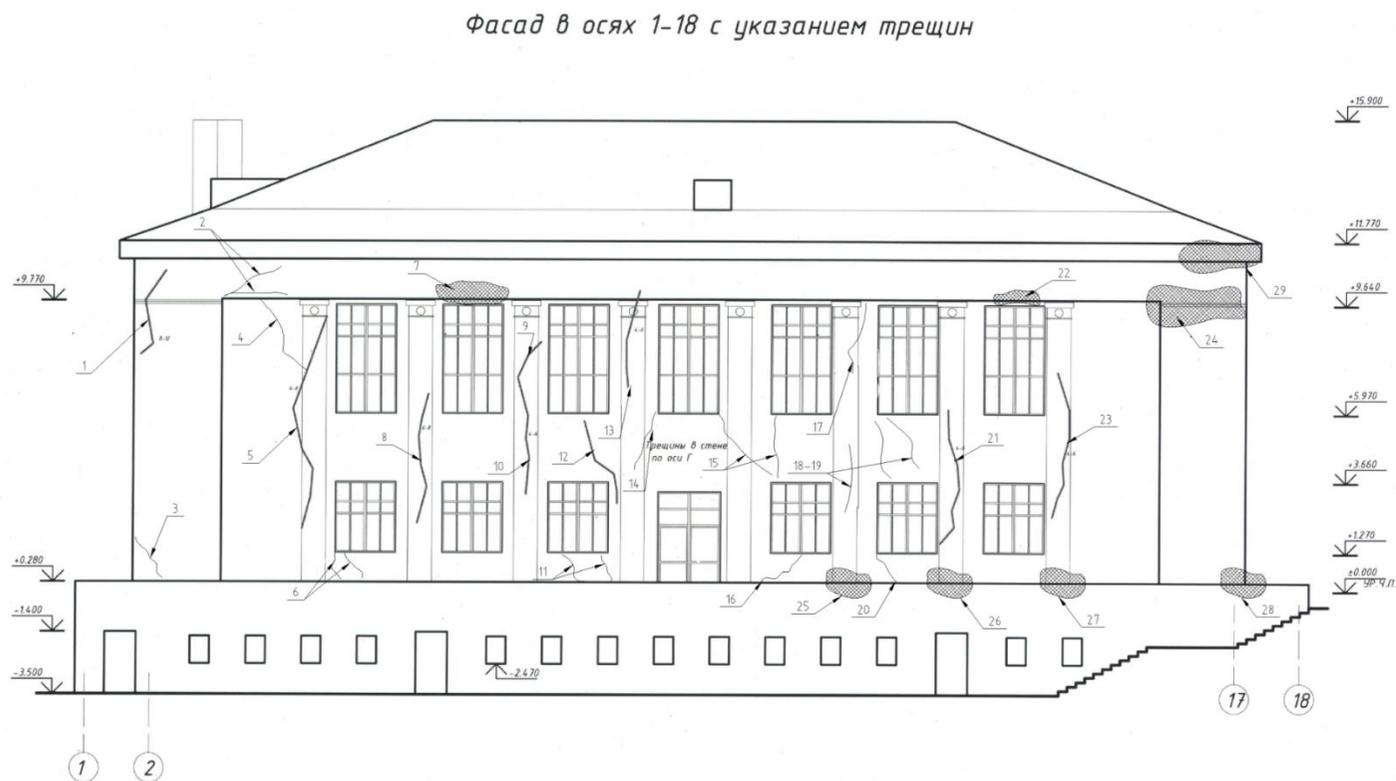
Пример схемы расположения дефектов на фасаде здания в осях А-Г/1-18
